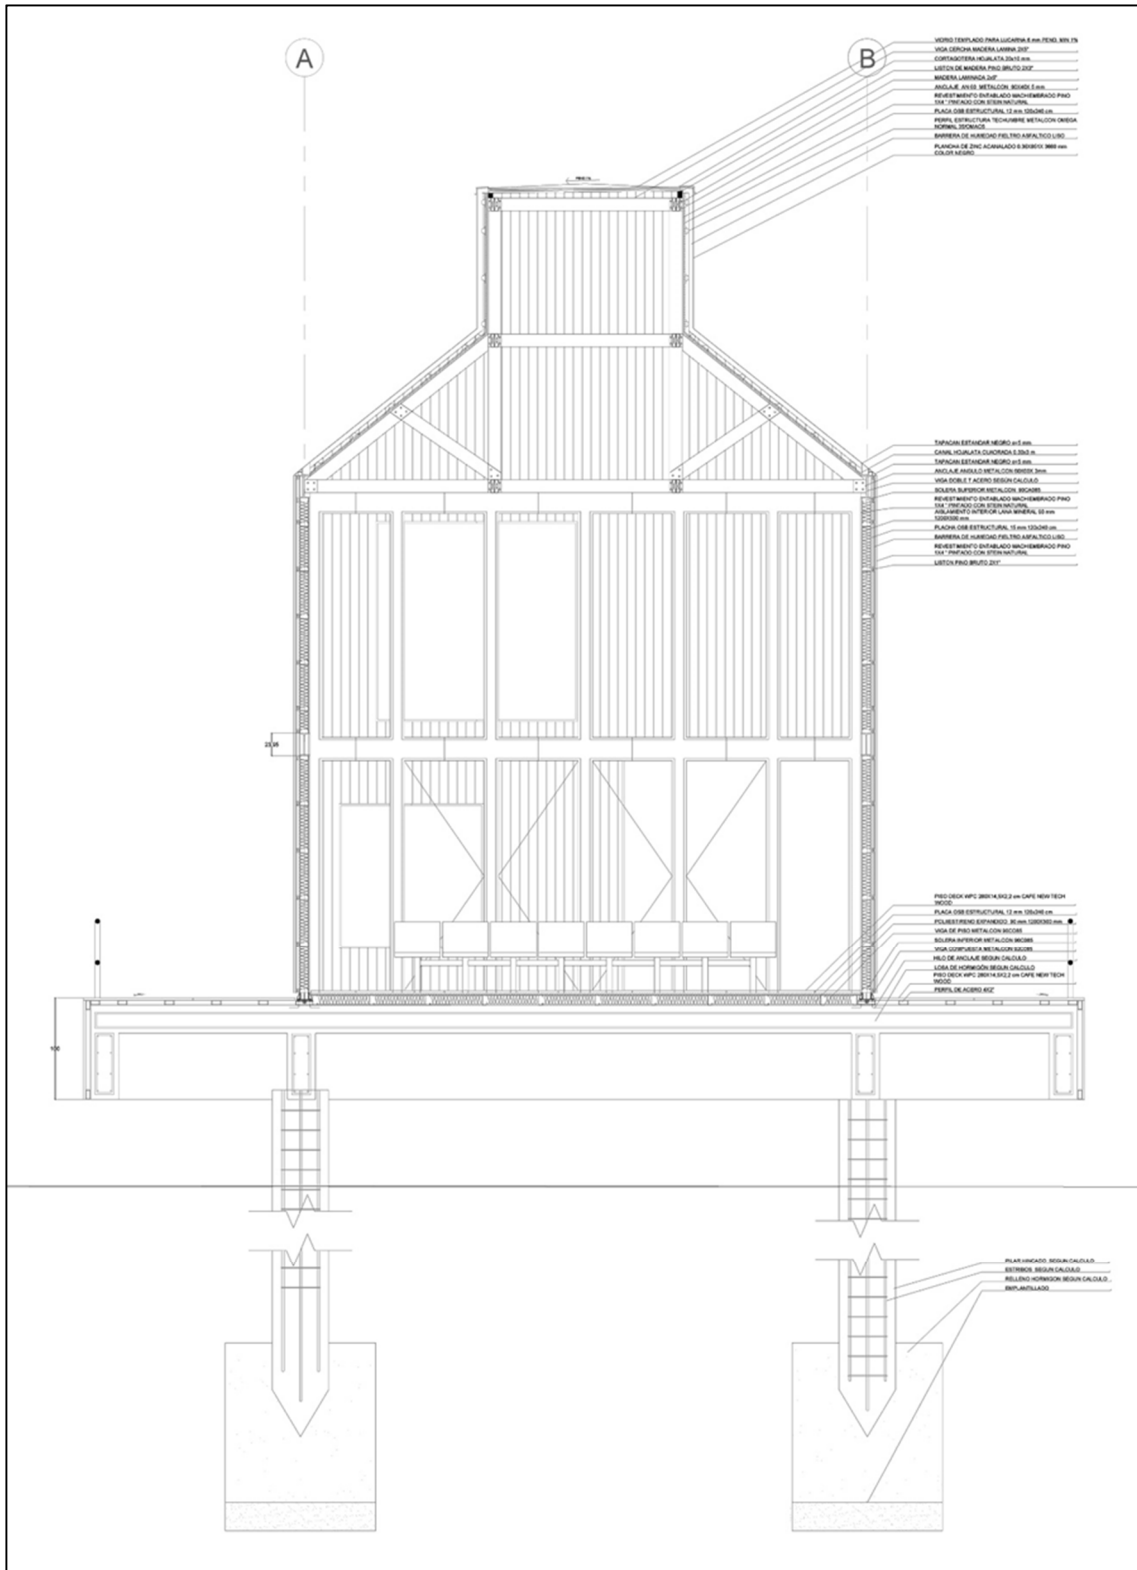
CORTE CONSTRUCTIVO TRANSVERSAL POR SALA DE ESPERA
